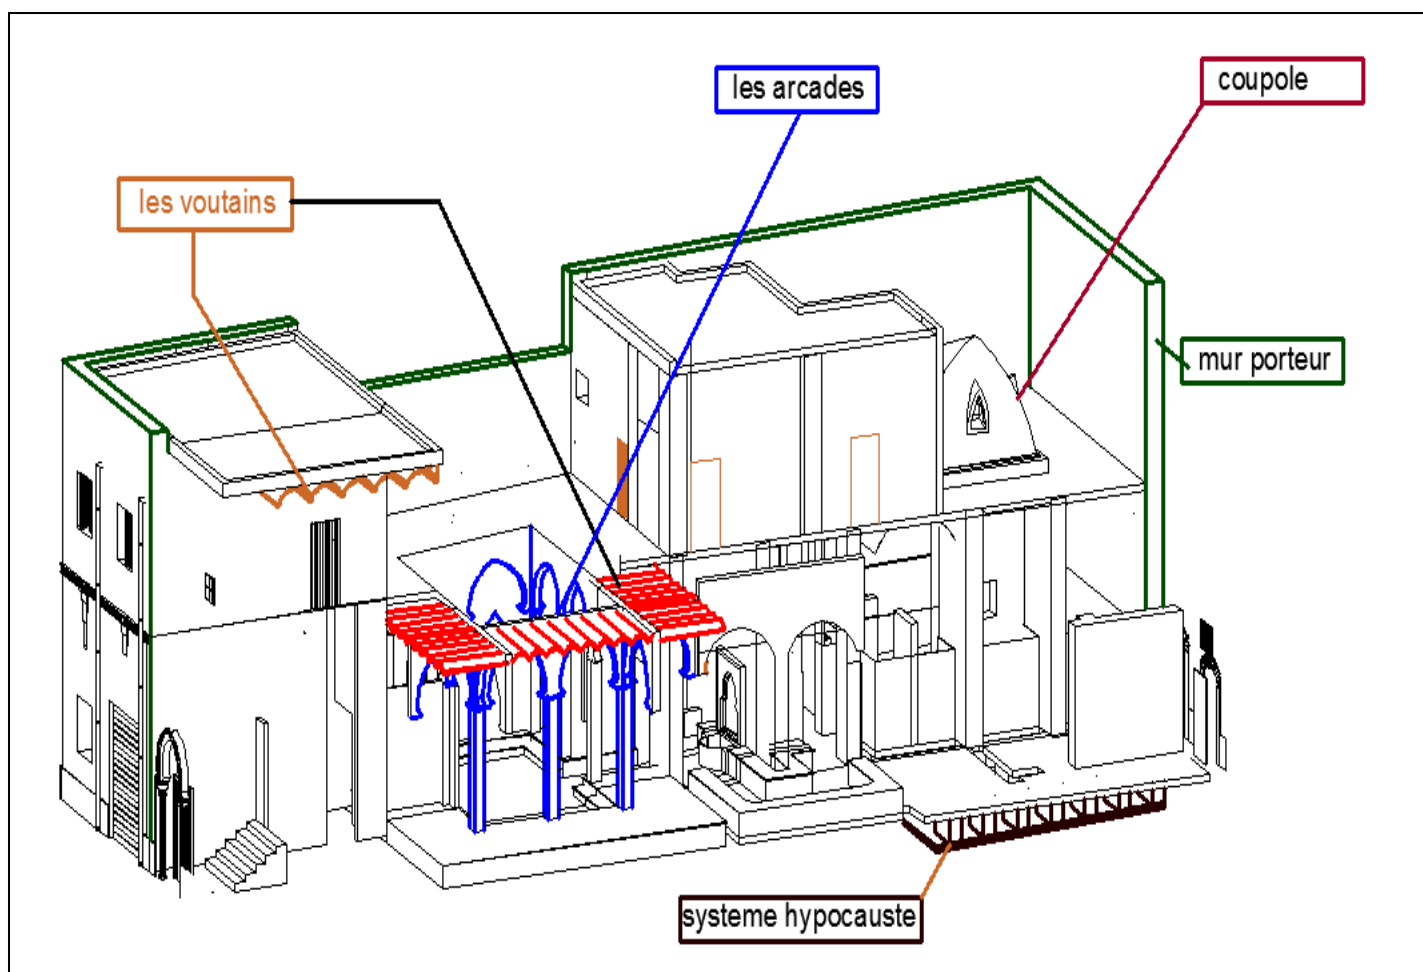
Schéma sur le système constructif de hammam el-Saada
